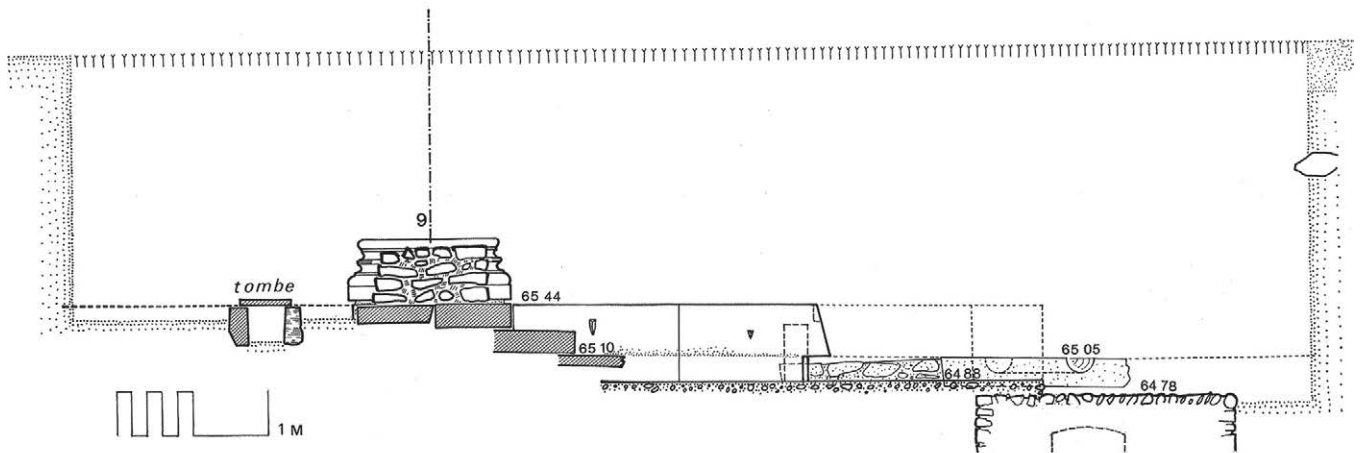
Coupe transversale sur le perron sud (G. Hallier).
